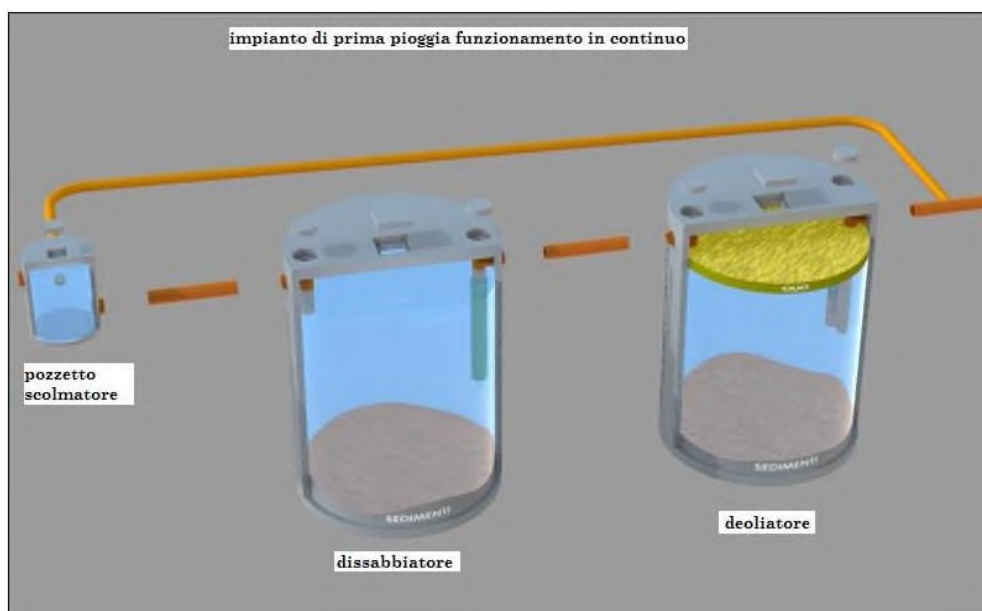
Schema funzionamento impianto di prima pioggia
